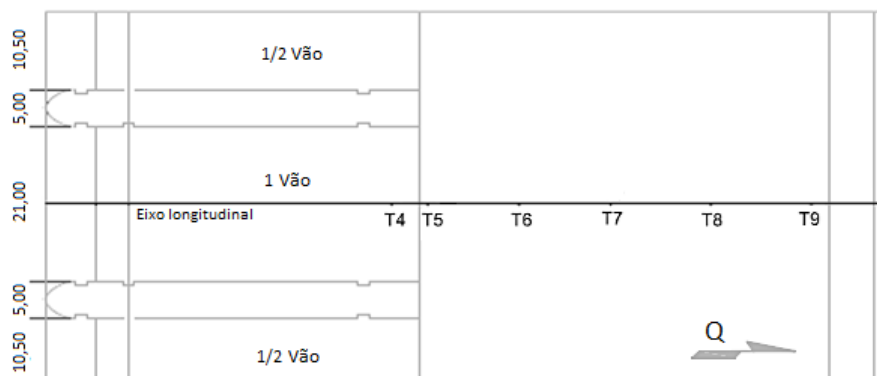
Planta baixa do modelo do vertedouro e bacia de dissipação da UHE São Manoel na escala 1:60, com larguras de vãos e pilares em dimensões de protótipo em metros, e disposição das tomadas de pressões no trecho plano da bacia.
